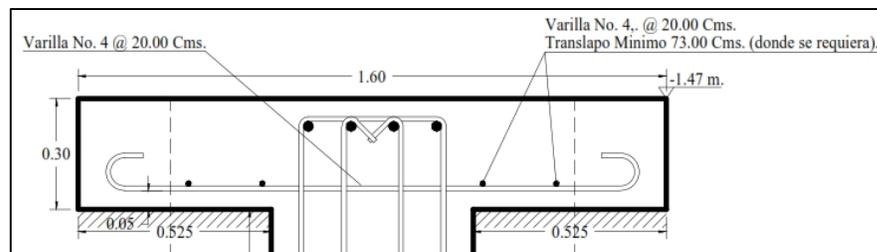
, Detalle zarpa eje 8, Fuente: Constructora Open House
